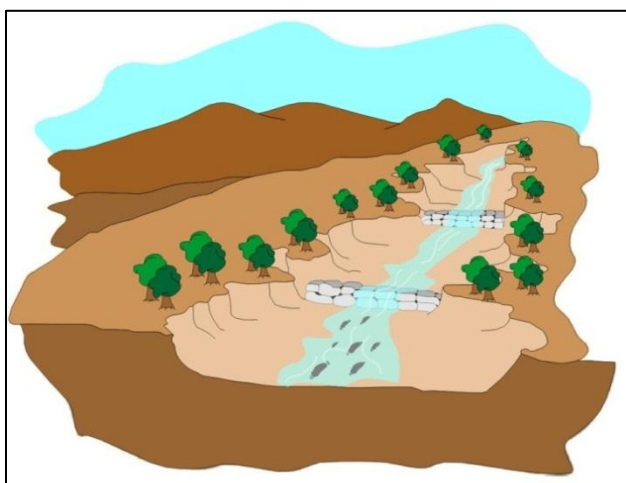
Presas transversales o aliviaderos, que podrían construirse en el valle Llacllato.
